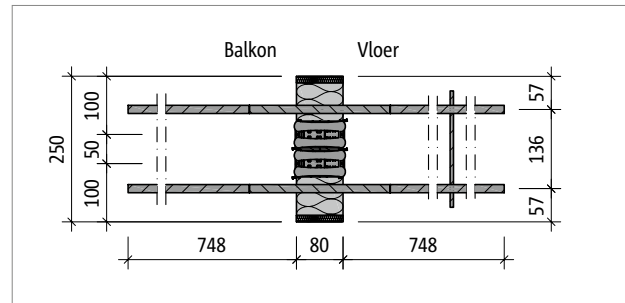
Schöck Isokorb® T type Q-E-V6-L500: Bovenaanzicht
